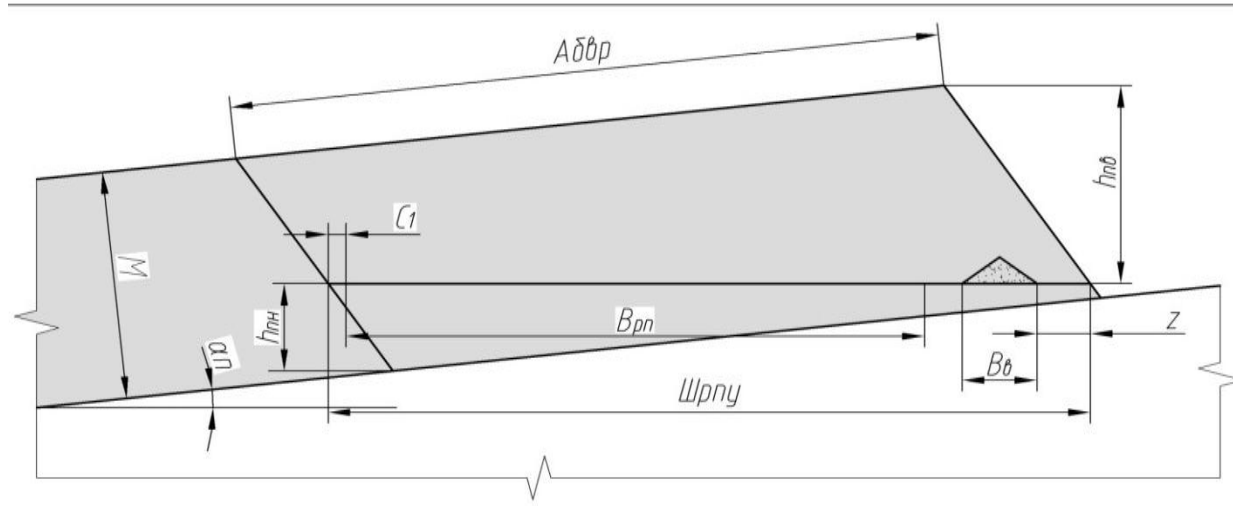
Схема к определению ширины рабочей площадки при отработке угольного пласта пологого залегания
